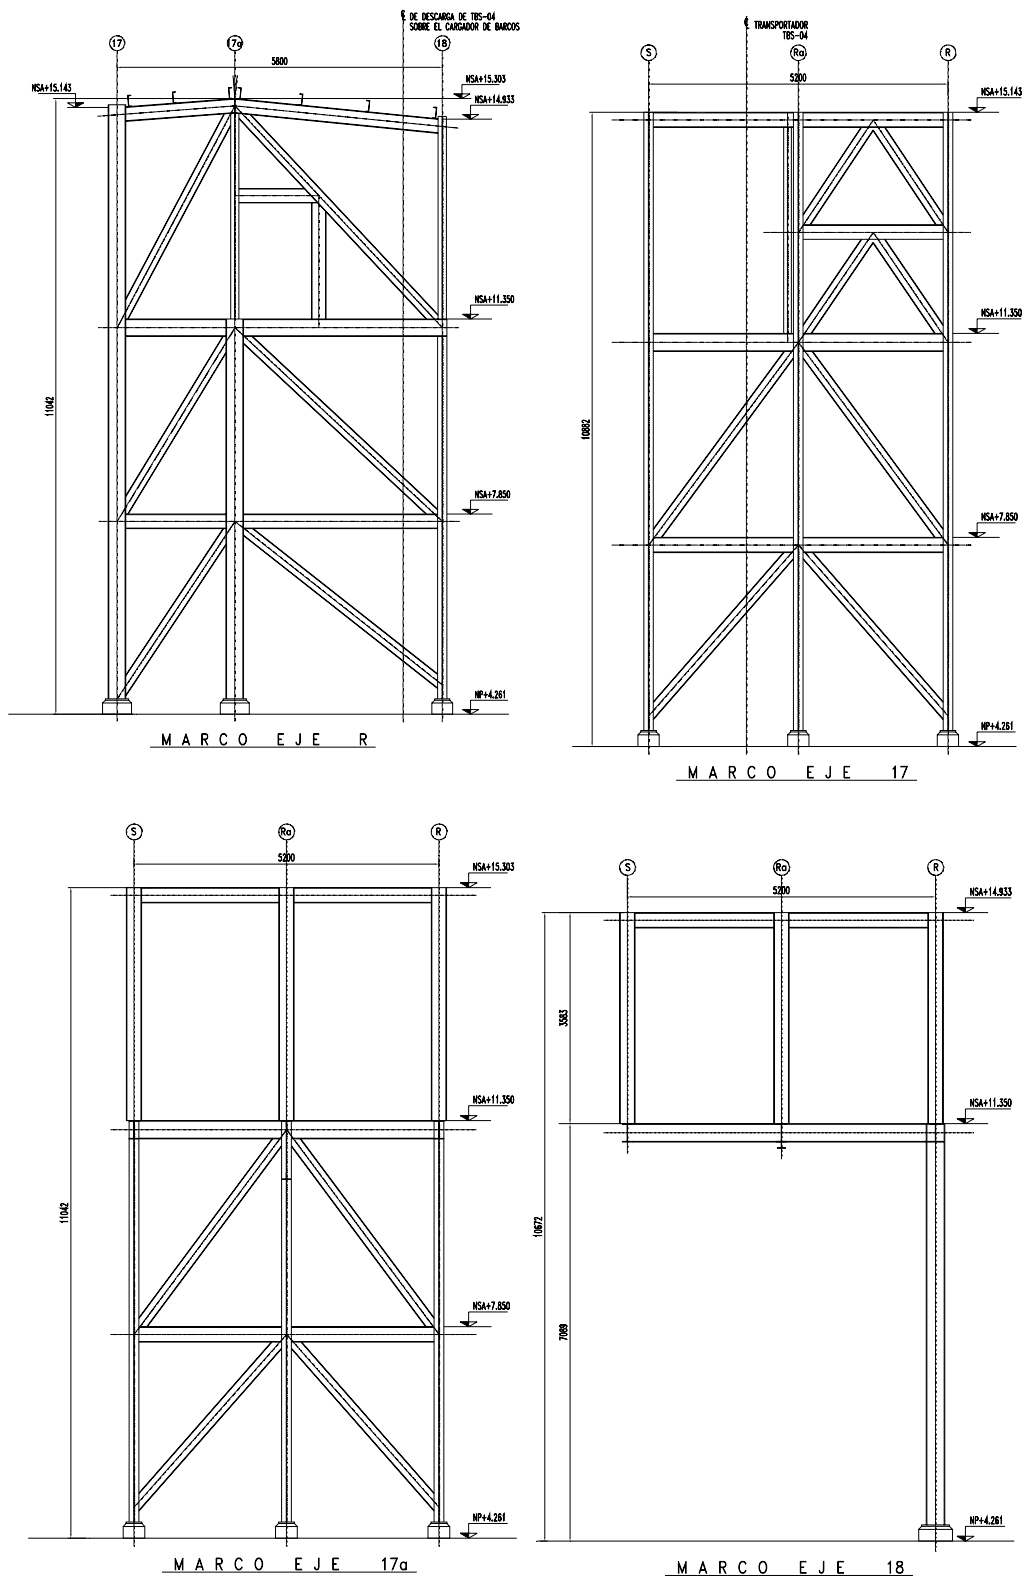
Elevaciones de Marcos Estructurales en Torre TT-5
